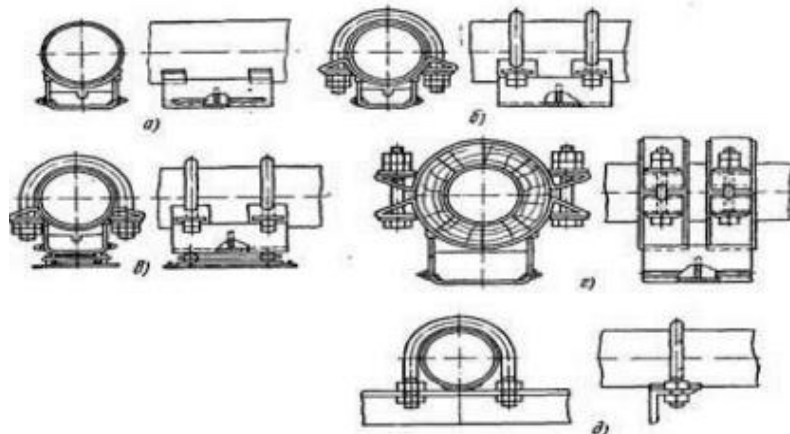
Конструкция подвижных опор трубопроводов, где: а – приварная скользящая; б – хомутовая скользящая; в – хомутовая скользящая двухкатковая; г – хомутовая скользящая для трубопроводов с хладагентом; д – направляющая
